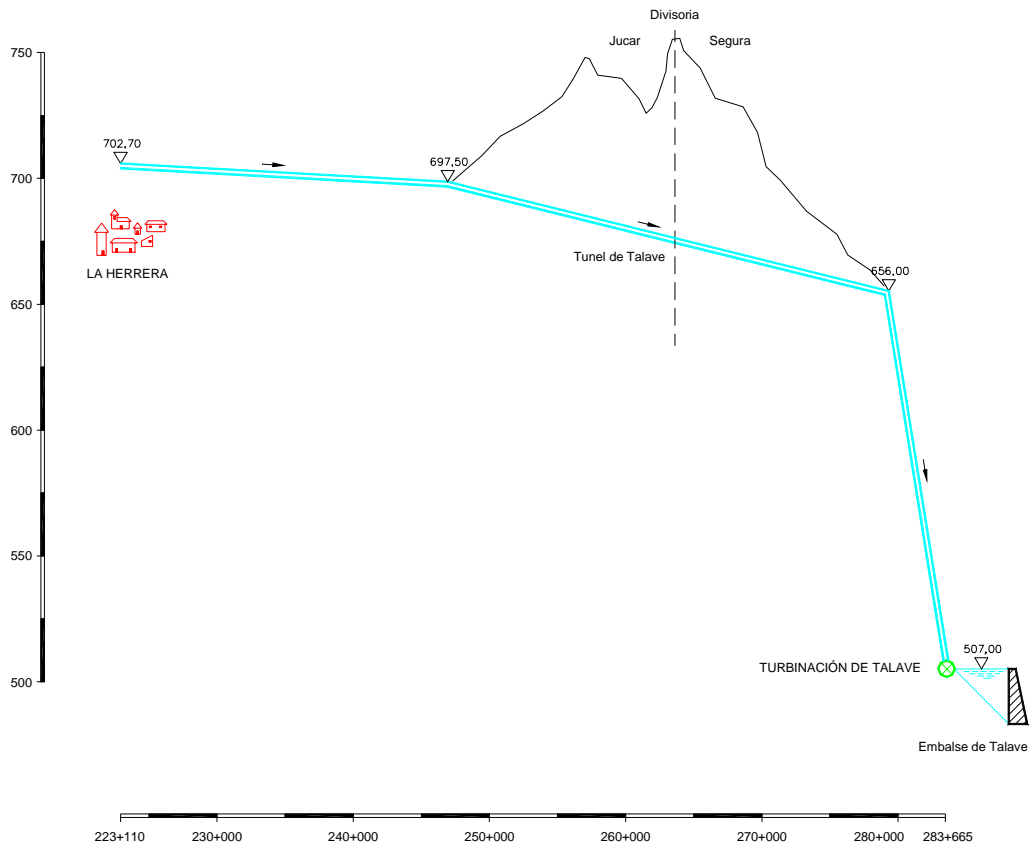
Conducción La Herrera-Talave. Esquema en alzado
